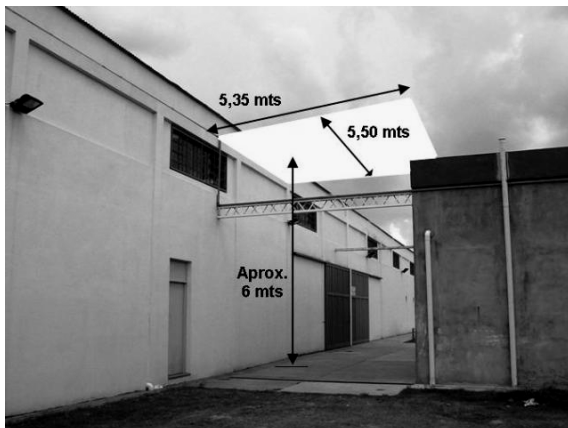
Plataforma elevada para instalación del Banco de ensayos UTN-FRBA
